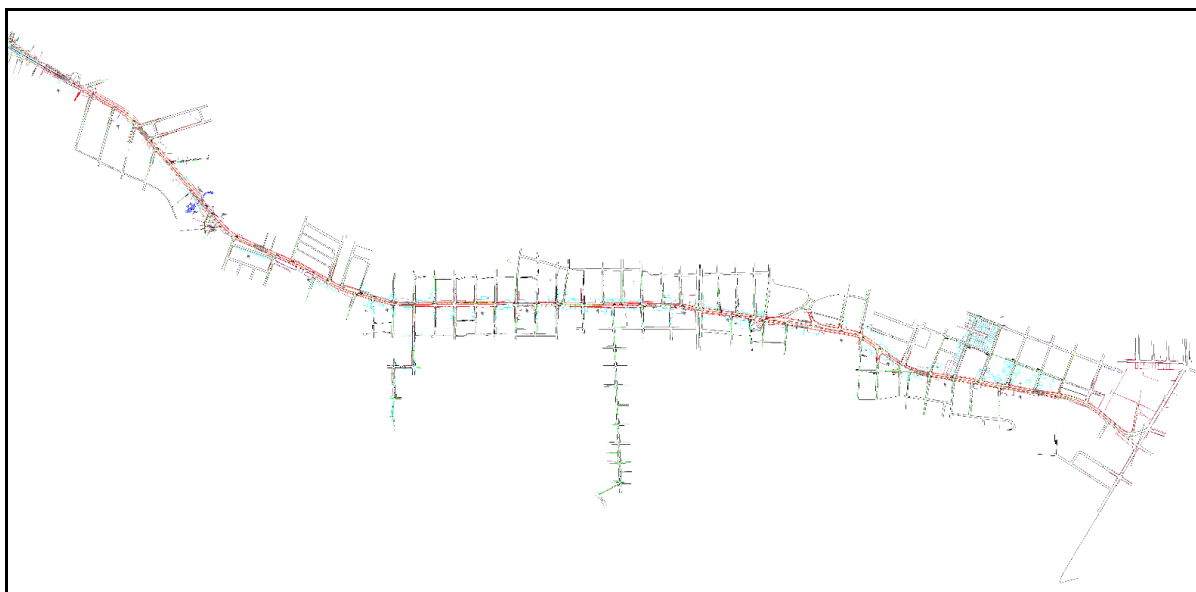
Planta geral do trecho entre a Rua Heróis do Acre e Av. Germano Franck.
